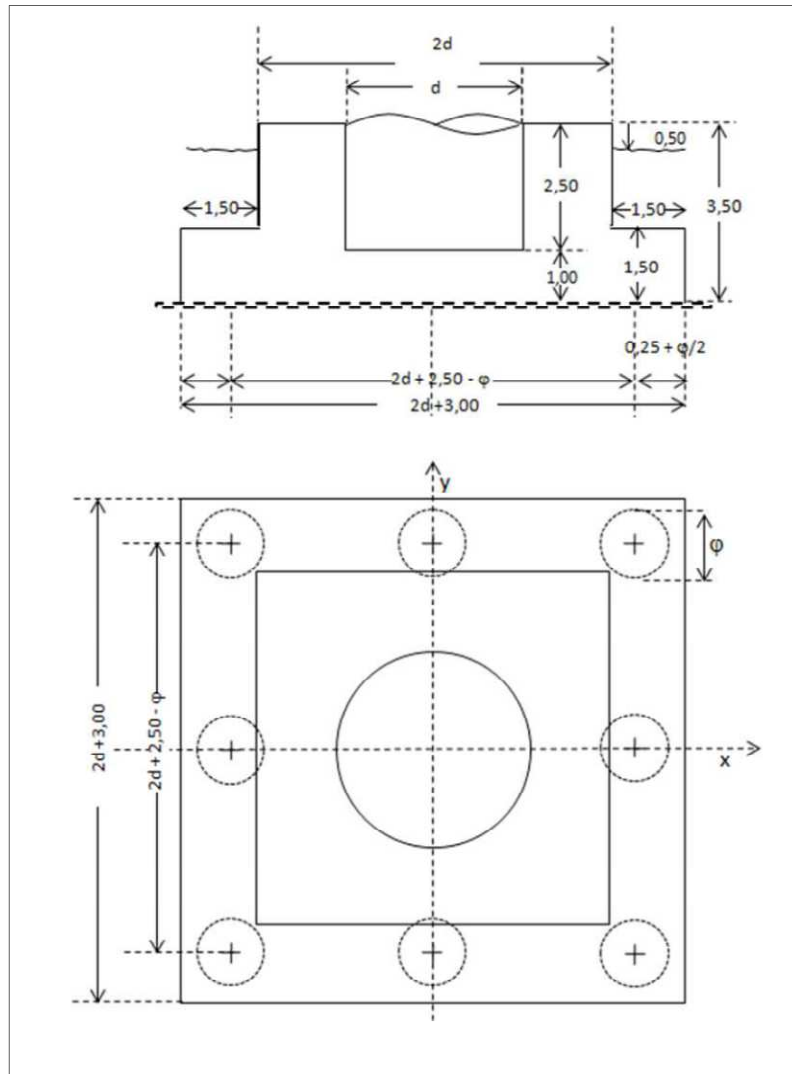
Schema tipo di fondazione profonda su n. 8 pali trivellati.
